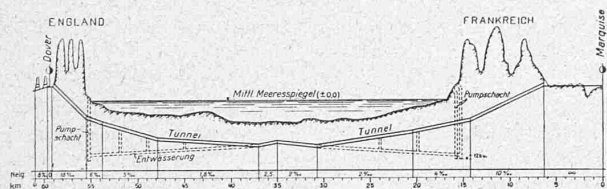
und 2. Lageplan und Längensprofil zum Kanal-Tunnel nach Projekt Sartiaux. — Abb. 3. Tunnel-Querschnitt 1:200.
